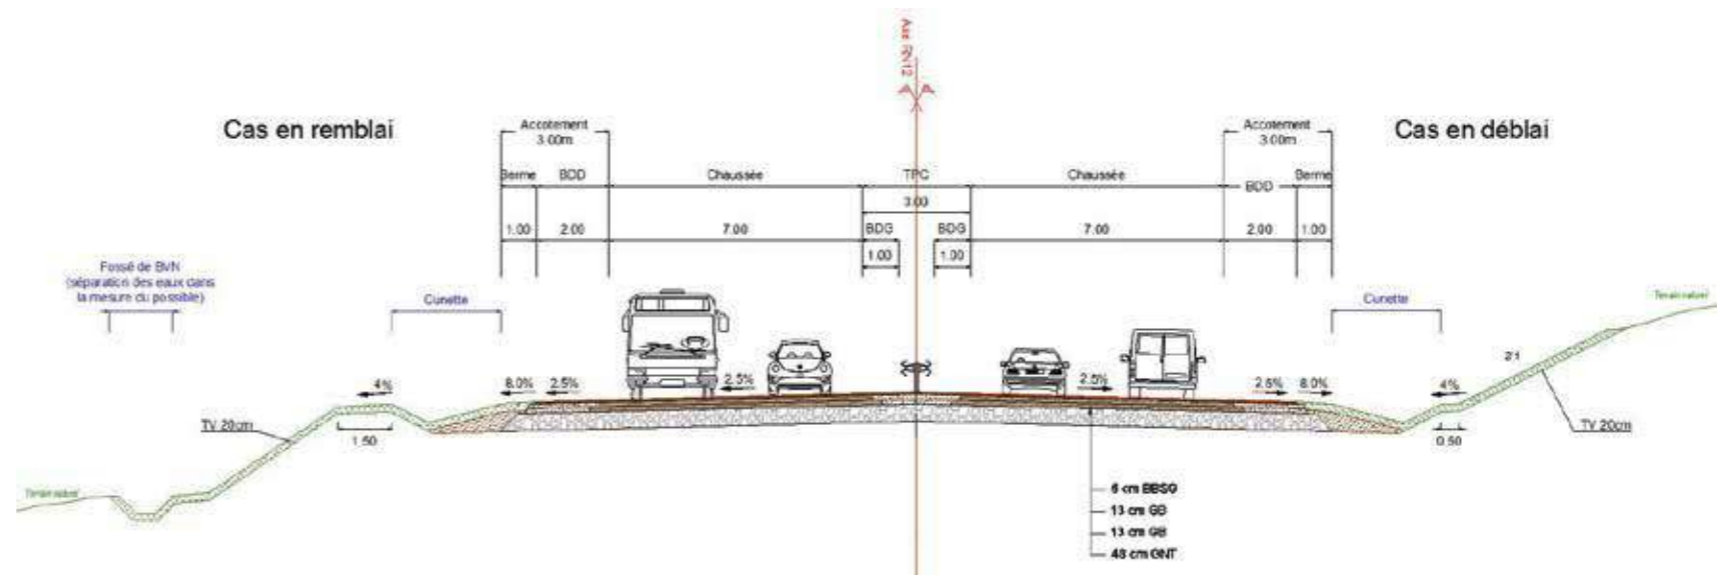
PROFIL EN TRAVERS CRÉNEAU DE DÉPASSEMENT À 2X2 VOIES
